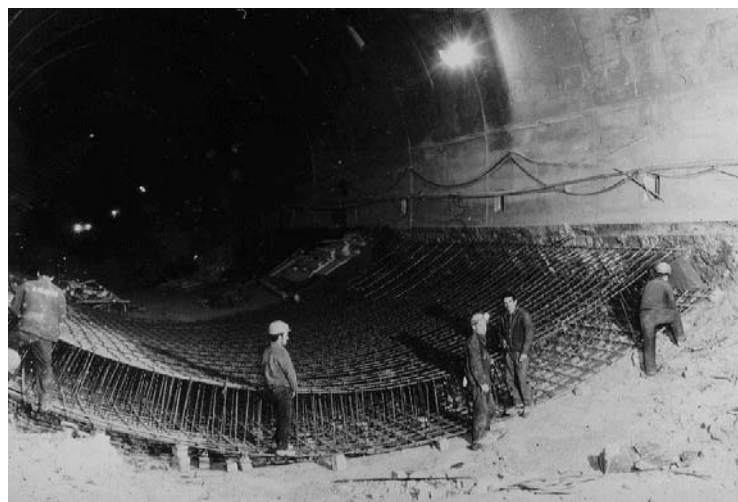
Belchentunnel: Sanierung der zerstörten Sohlabschnitte durch den Einbau eines 85 cm starken, bewehrten Sohlgewölbes (Schillinger, 1970)
